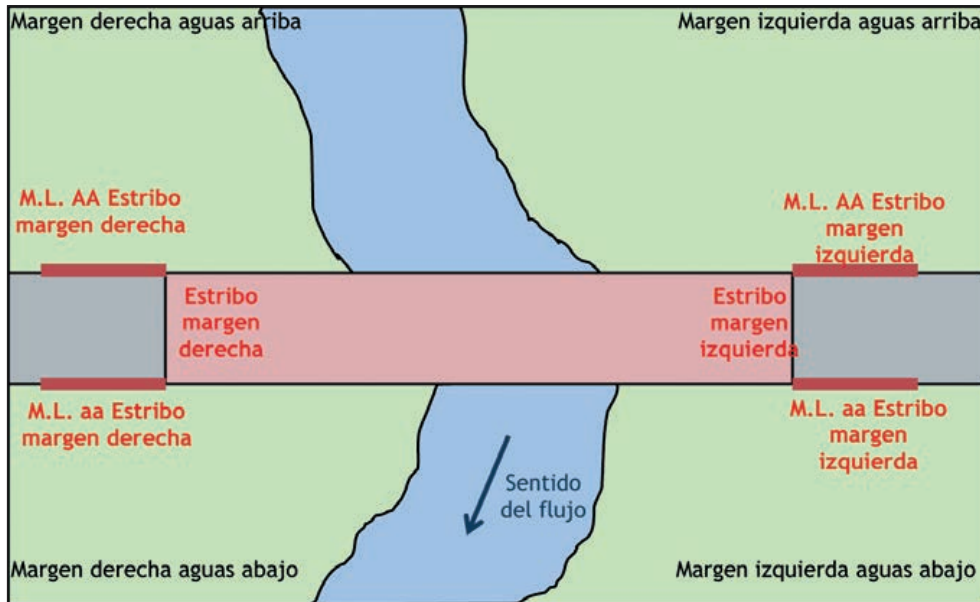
NUMERACIÓN DE ELEMENTOS EN LOS ESTRIBOS DEL PUENTE.
